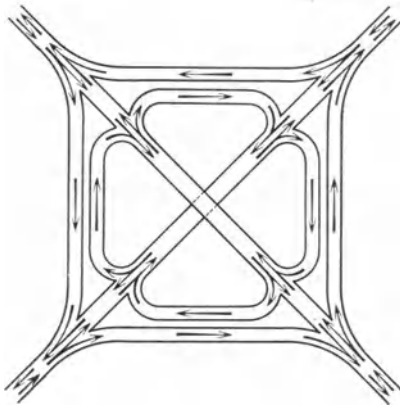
Kreuzung zweier Hauptstraßen im Staate New Jersey mit Trennung aller Verkehrsrichtungen, Schema [A 47].
